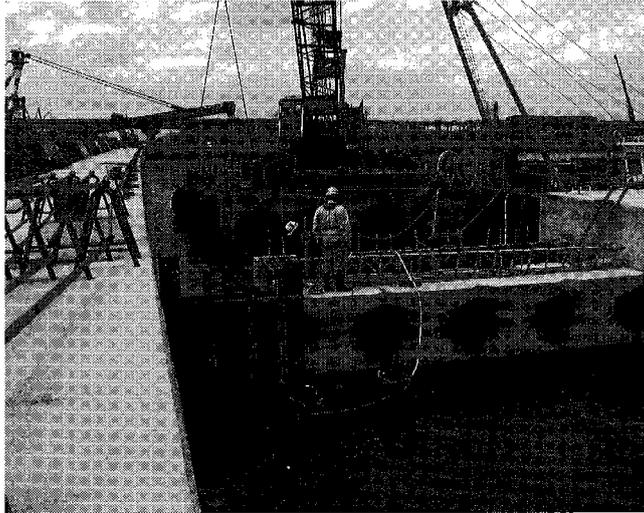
水中不分離コンクリート型枠建て込み状況
